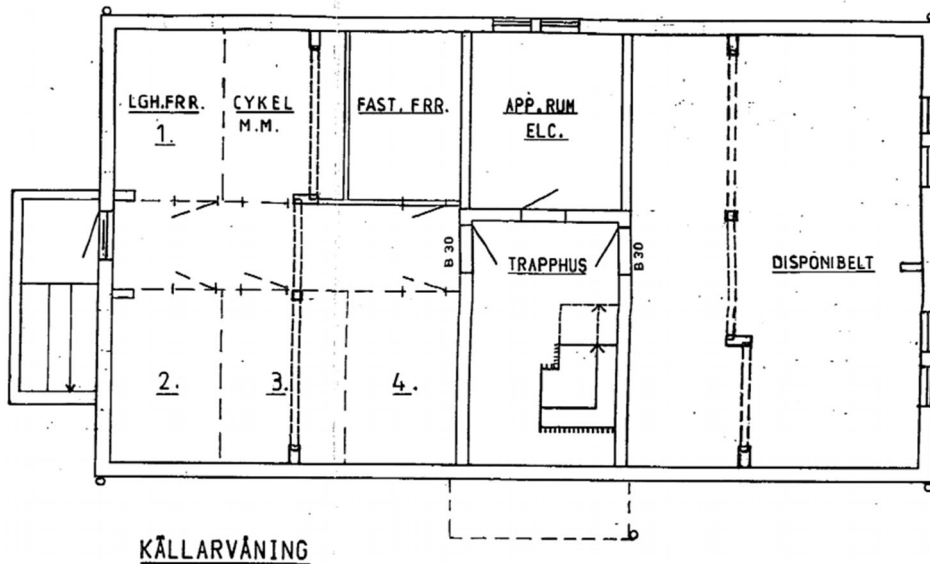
Ursprunglig planlösning, se bilaga *Bef. planritning sektion.pdf
